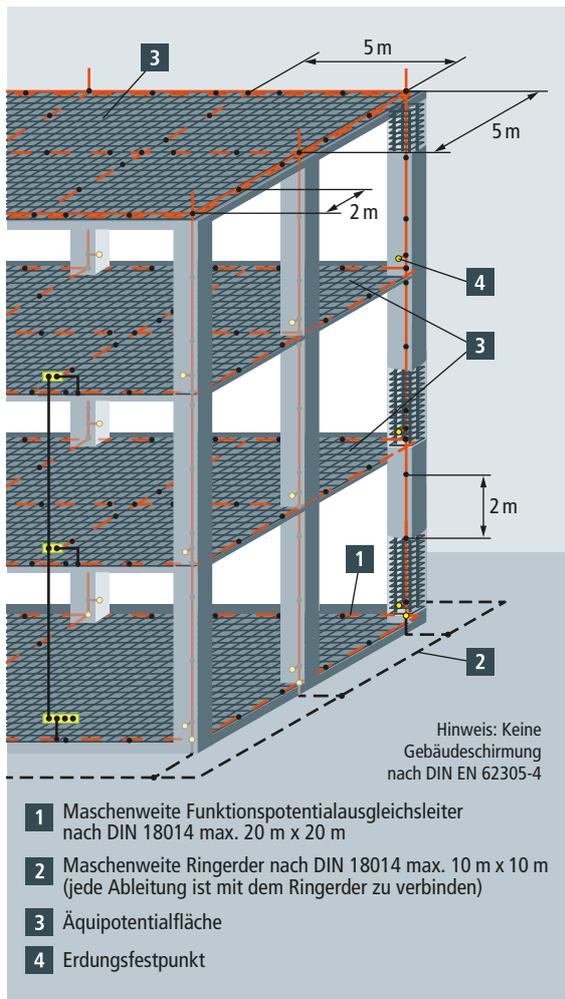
Gebäude mit Äquipotentialflächen und Fangeinrichtung (optional z. B. für Vorhangfassade)
